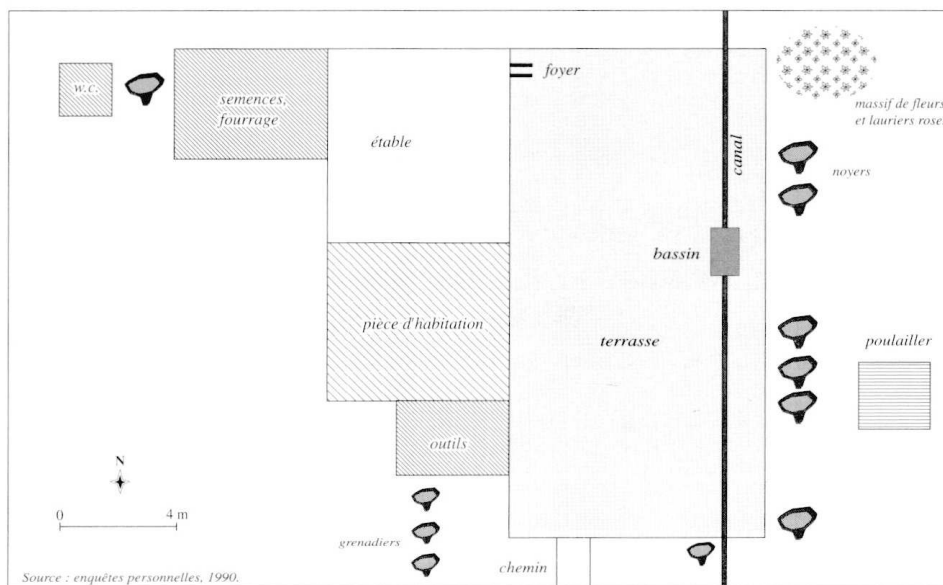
Exemple d'une maison de jardin (A.S., zūr al-Ḥarāb. Homs) : disposition rez-de-chaussée.
